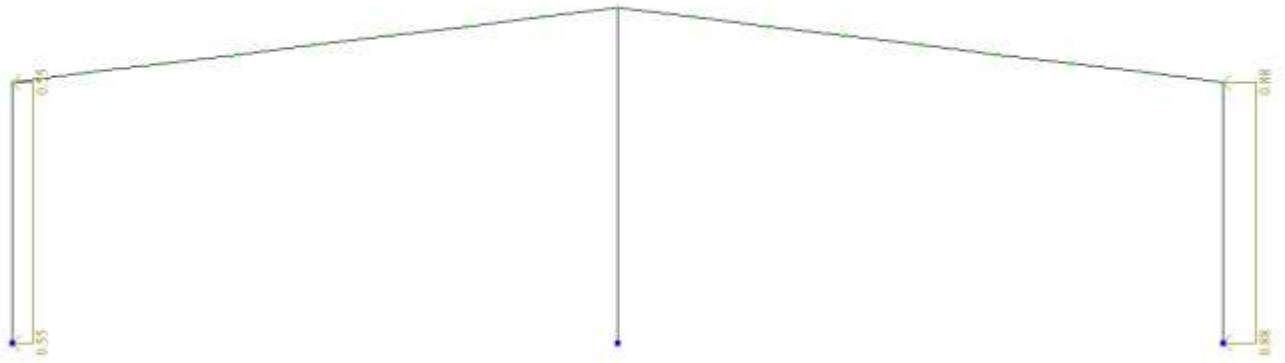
Схема загрузки поперечной рамы ветровой нагрузкой – ветер справа
